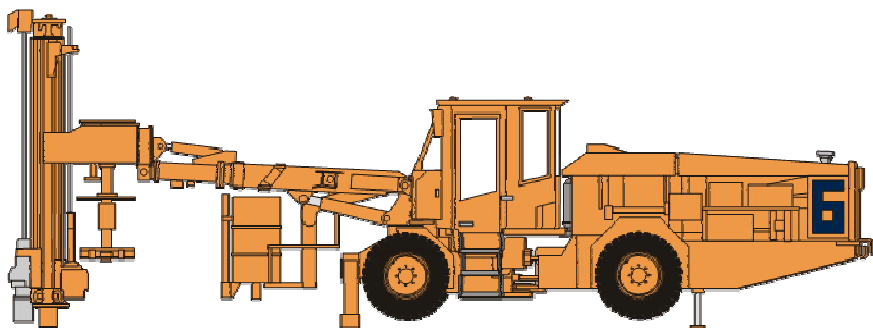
Общий вид установки для крепления анкерами Robolt 6-126 XL Cement Cabin
